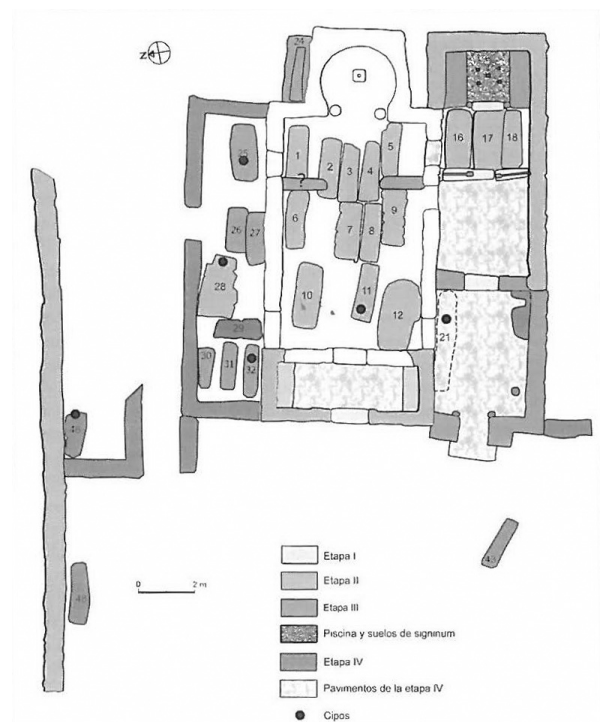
Planta de la Iglesia de El Gatillo donde se explican claramente las fases constructivas (Ilustración 5)
